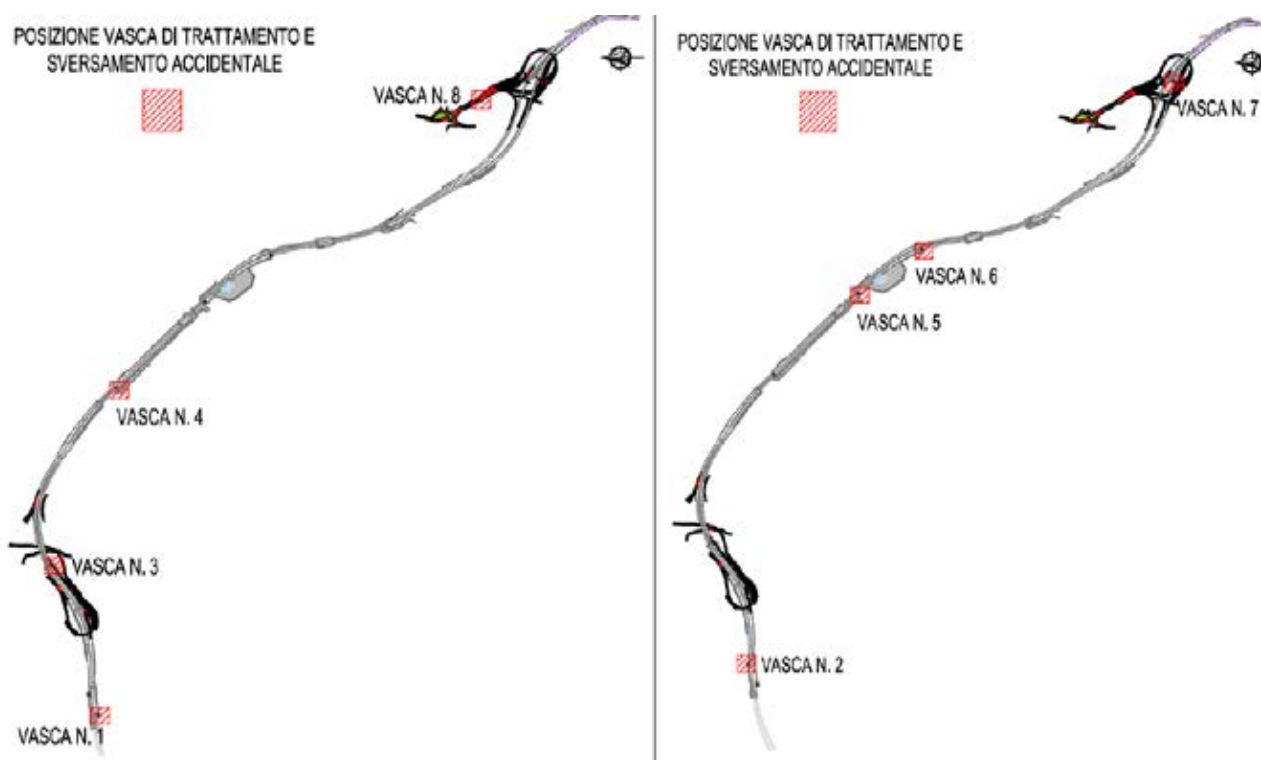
Stralci planimetrici del tracciato stradale con l'ubicazione delle due tipologie di vasche previste.
